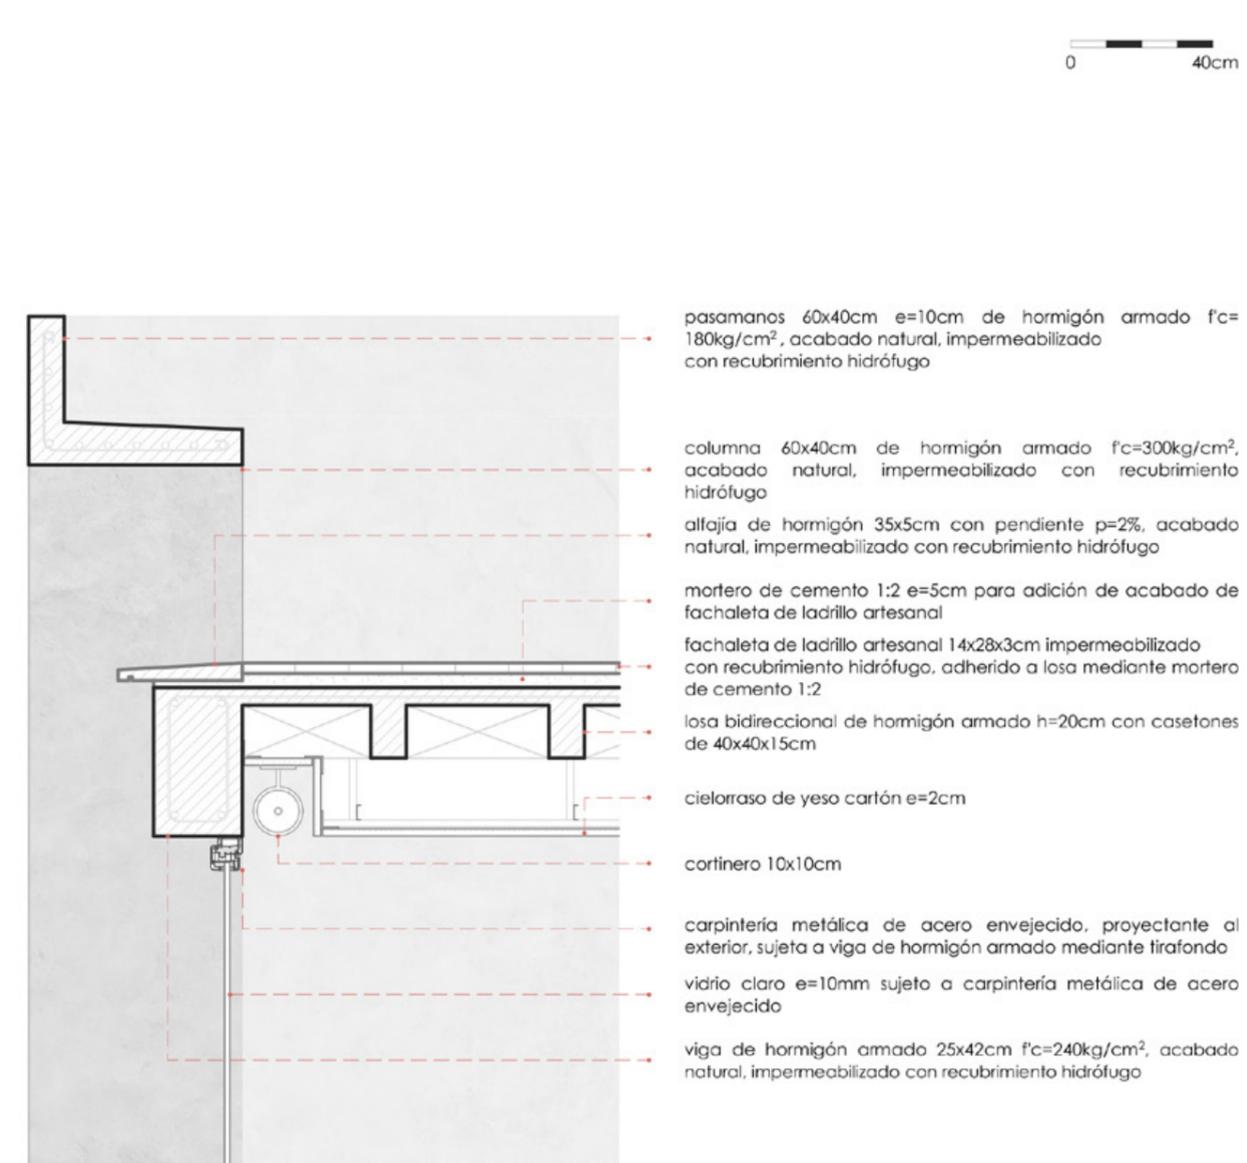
Detalle constructivo 1. Fuente: Elaboración propia.
